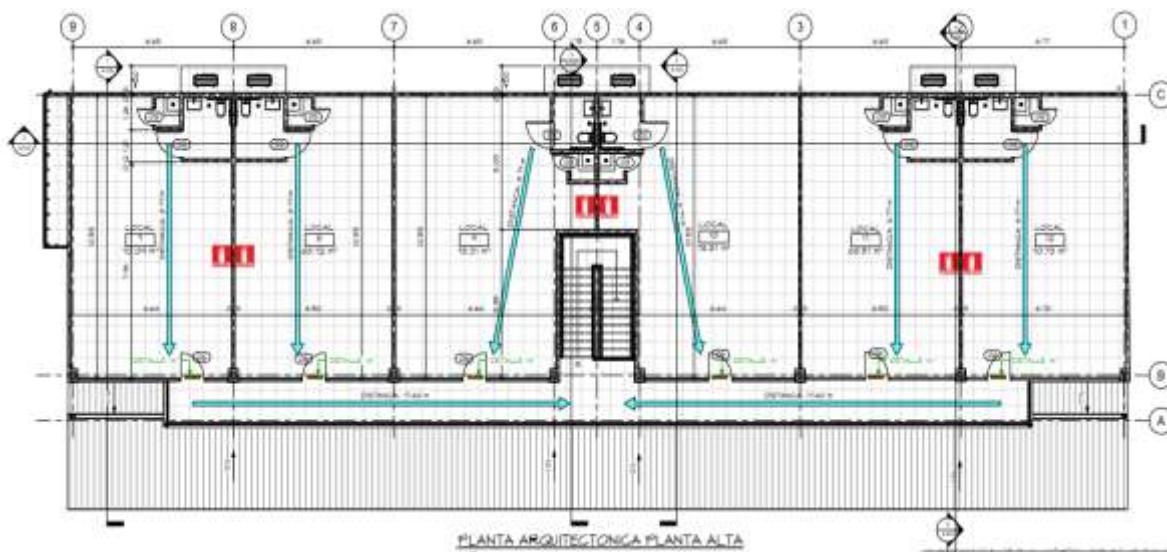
Planta arquitectónica PLANTA ALTA. Fuente: Plano del proyecto
